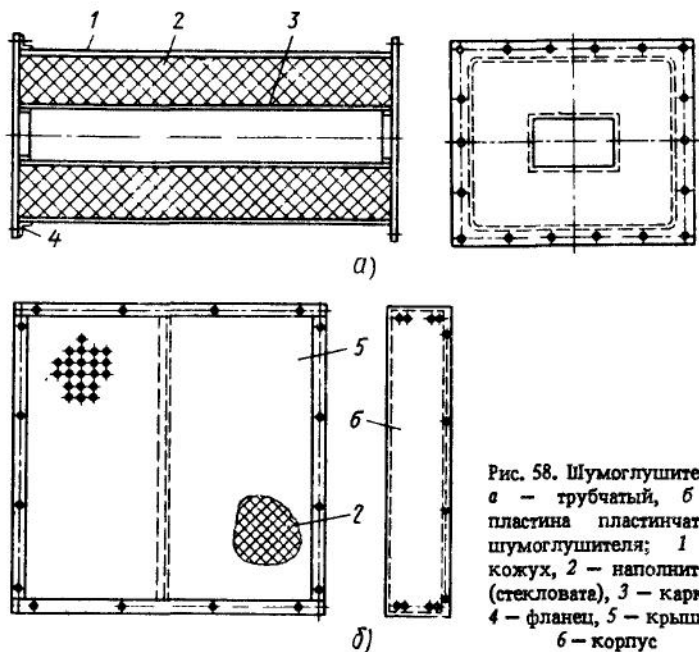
Шумоглушители: а — трубчатый, б — пластина пластинчатого шумоглушителя; 1 — кожух, 2 — наполнитель (стекловата), 3 — каркас, 4 — фланец, 5 — крышка, 6 — корпус
